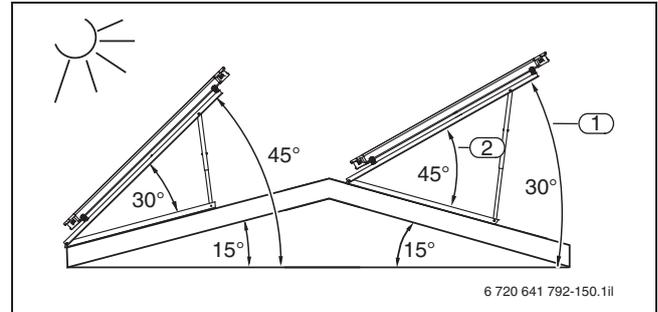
Esempi per l'effettivo angolo di inclinazione dei collettori piani utilizzando supporti per collettori su un tetto piano con poca inclinazione (< 25°)
